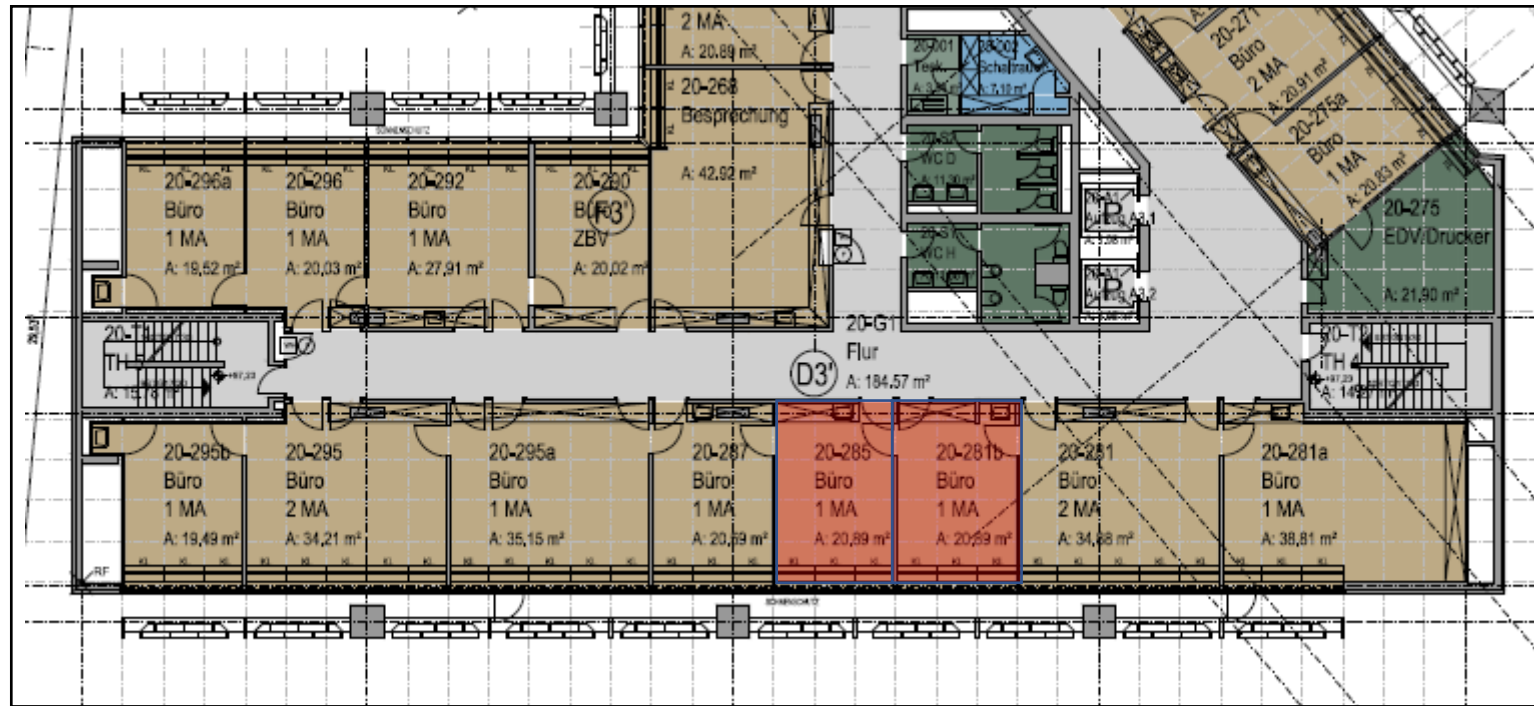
Detail Grundriss, agn Architekten, Januar 2017
